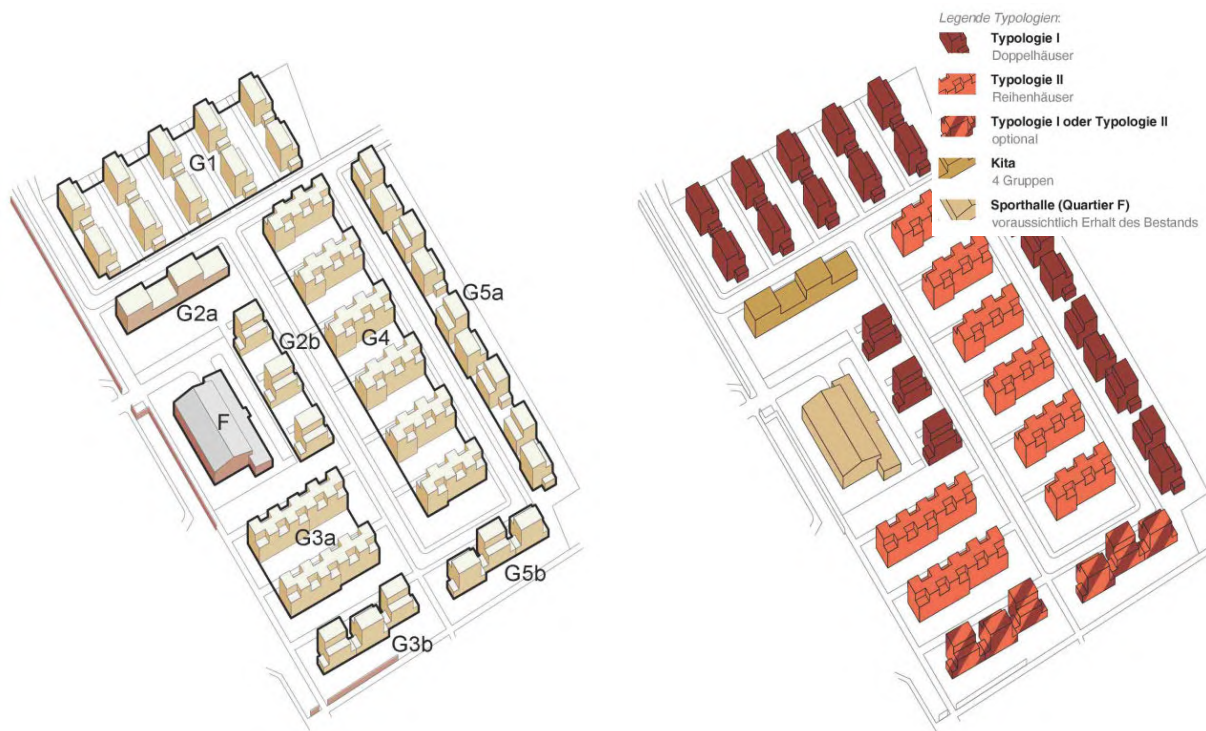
Struktur Grundstücke in Baufeld G (Planungsteam York)
